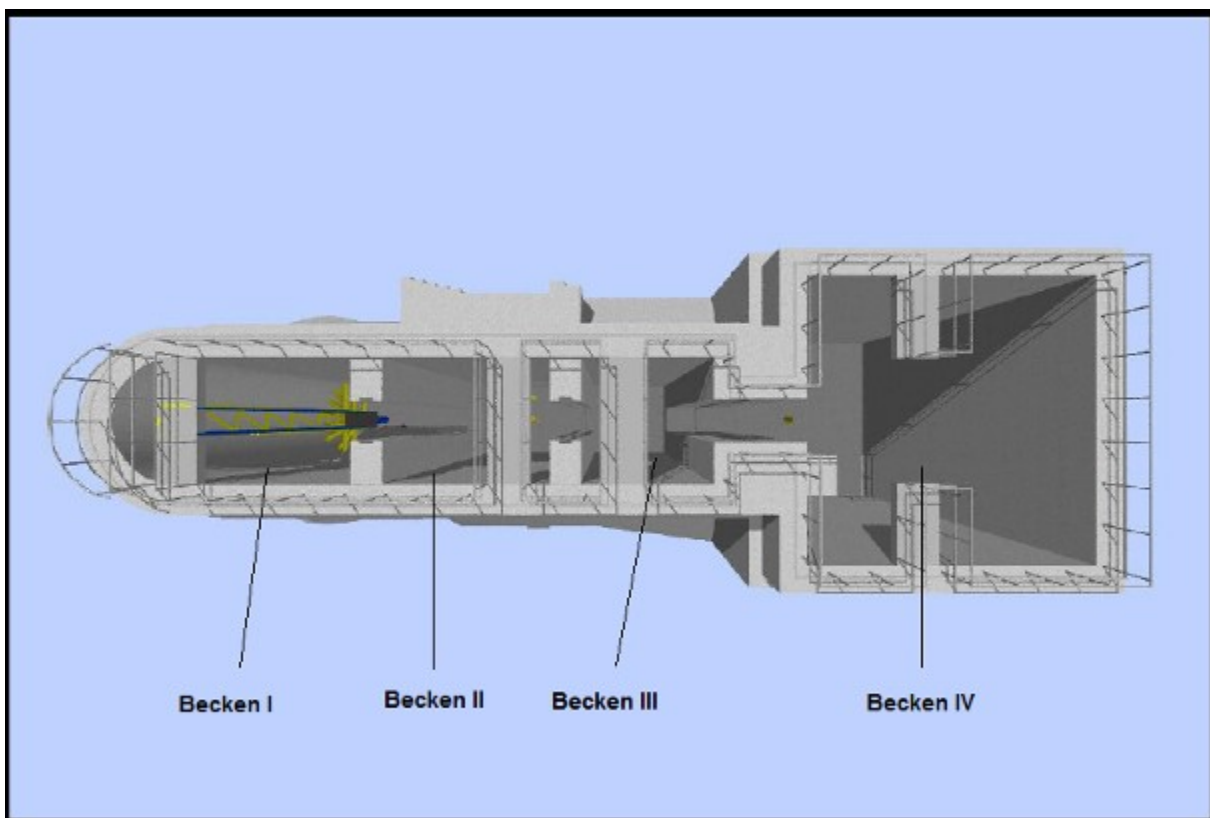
Draufsicht auf das Reaktorbecken
